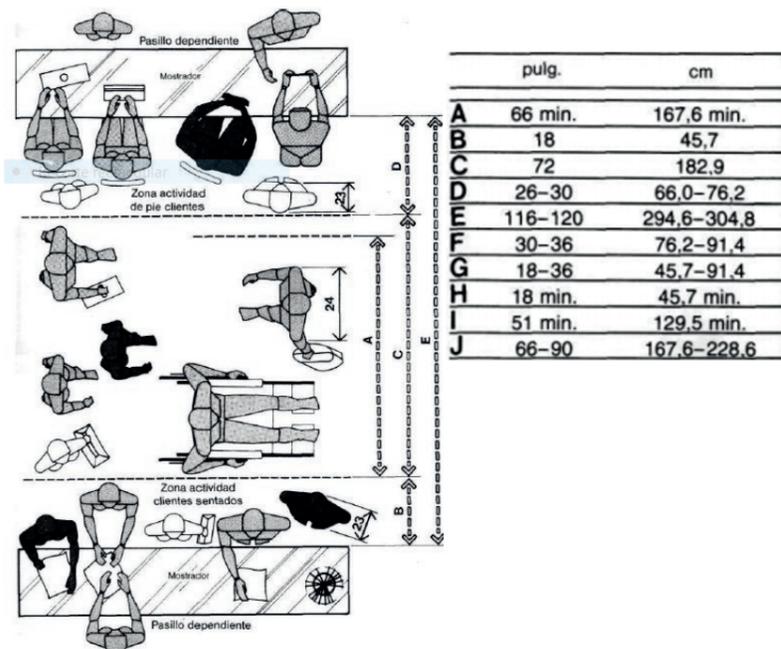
Dimensiones para anchuras de pasillos públicos principales.
